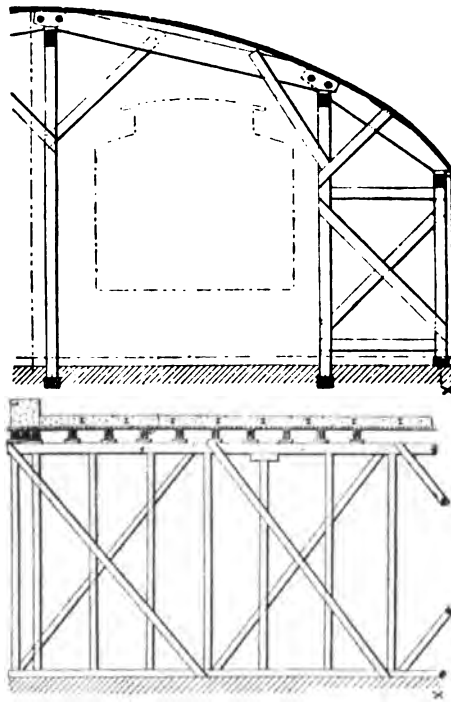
Stampfgerüst mit Durchgangsöffnung.
